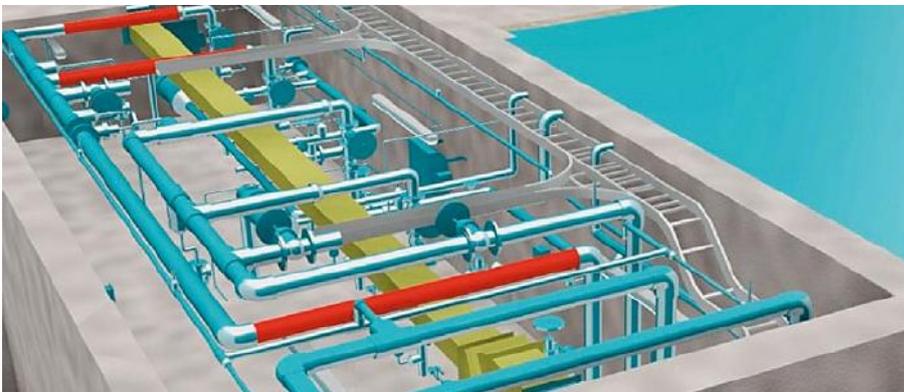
Kollisionsprüfung der Haustechnikgewerke <sup>92</sup>
